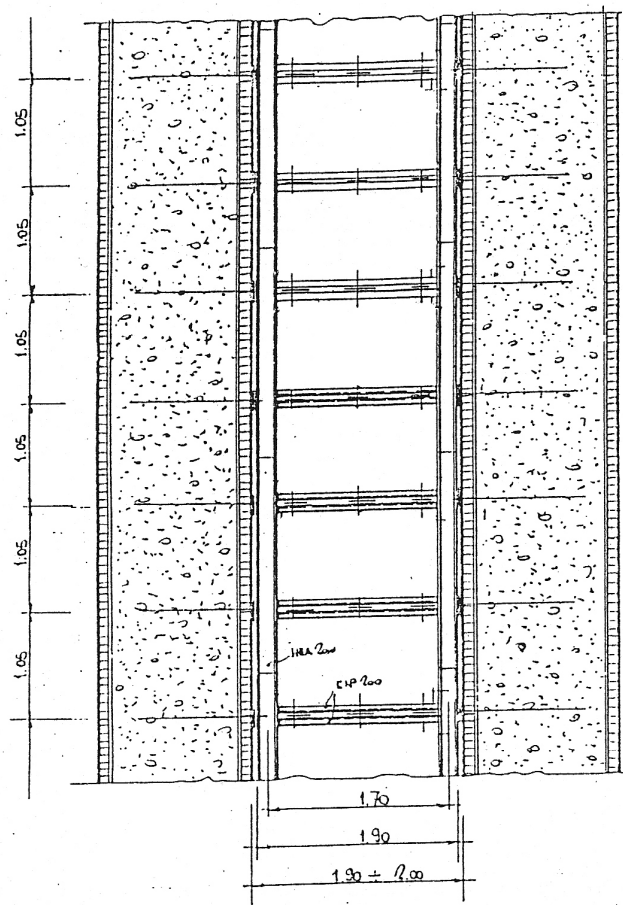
Progetto di consolidamento San Dalmazio: sezione verticale traliccio [9]
